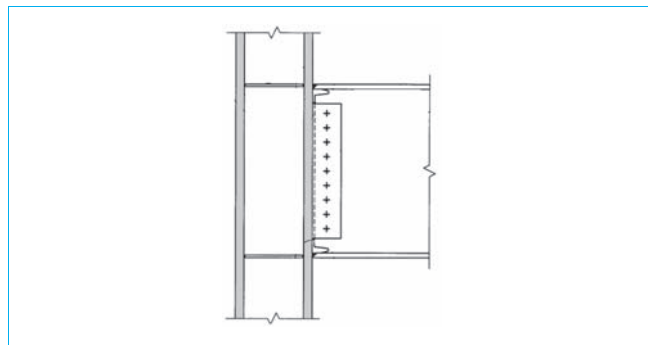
Assemblage poutre/poteau par ailes soudées et âme boulonnée à un gousset soudé sur l'âme du poteau (d'après la norme FEMA 350)
